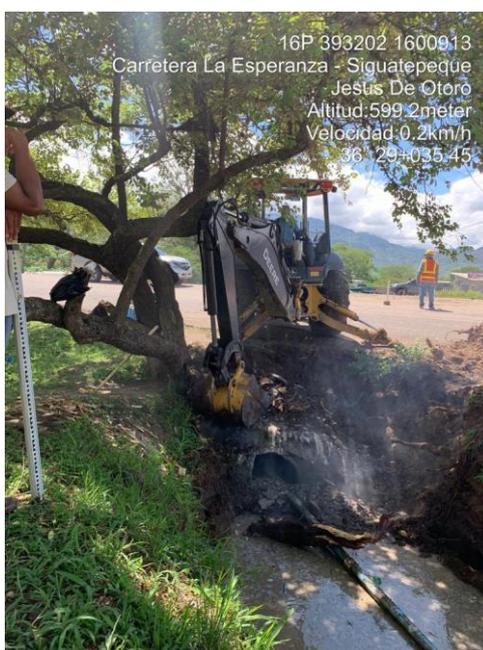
Canalización lado derecho en tubo de salida de alcantarilla
